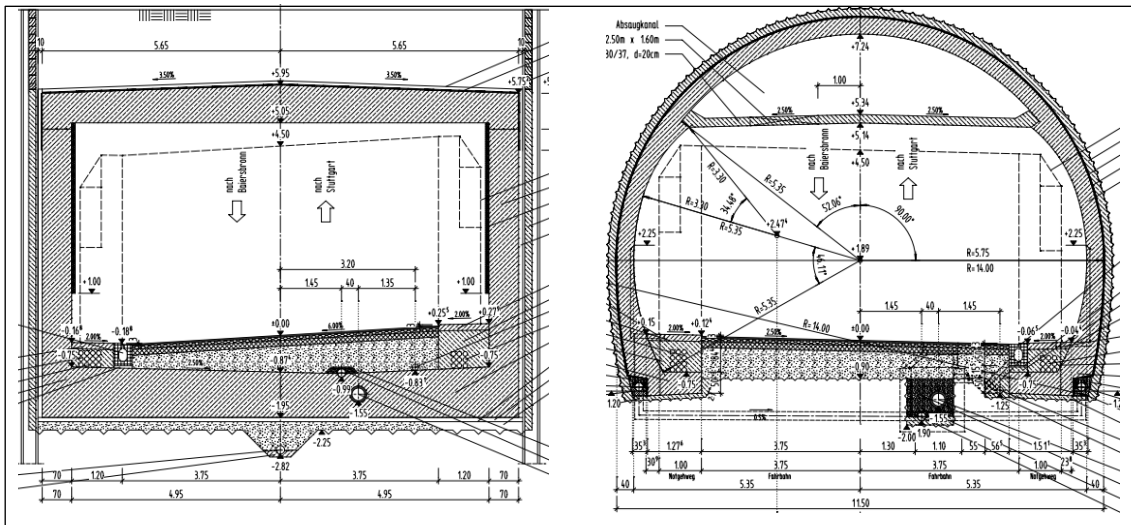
Regelquerschnitte Tunnel Freudenstadt – links: offene Bauweise (Rechteckprofil); rechts: geschlossene Bauweise (Gewölbeprofil) mit Zwischendecke
